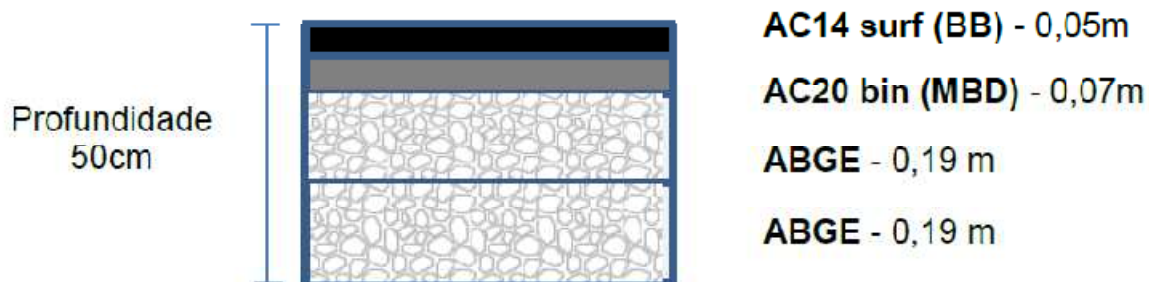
Estrutura de pavimento a adotar quando se efetue o saneamento de pavimentos
